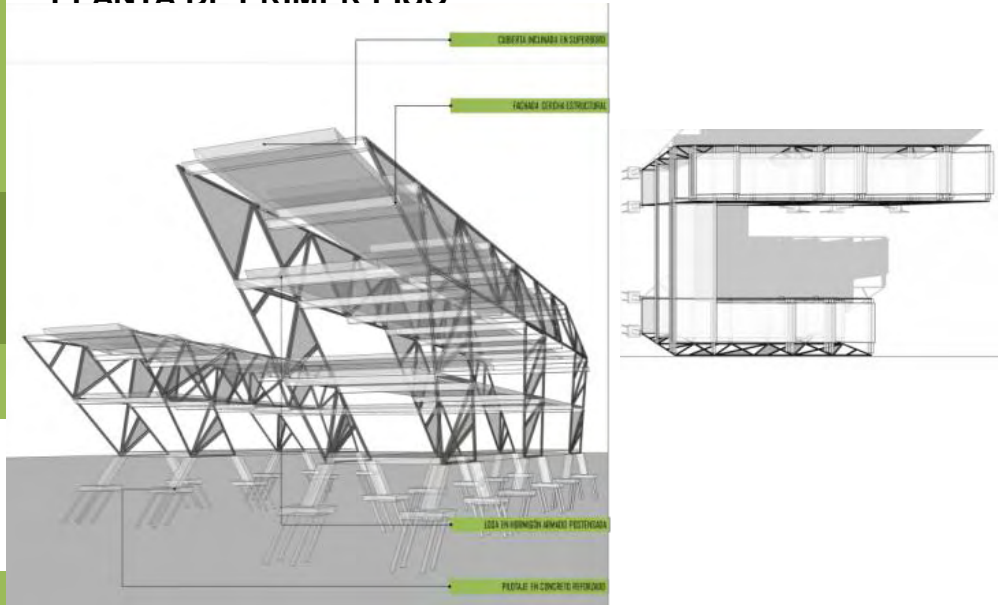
Propuesta 3ds Estructural del Proyecto
